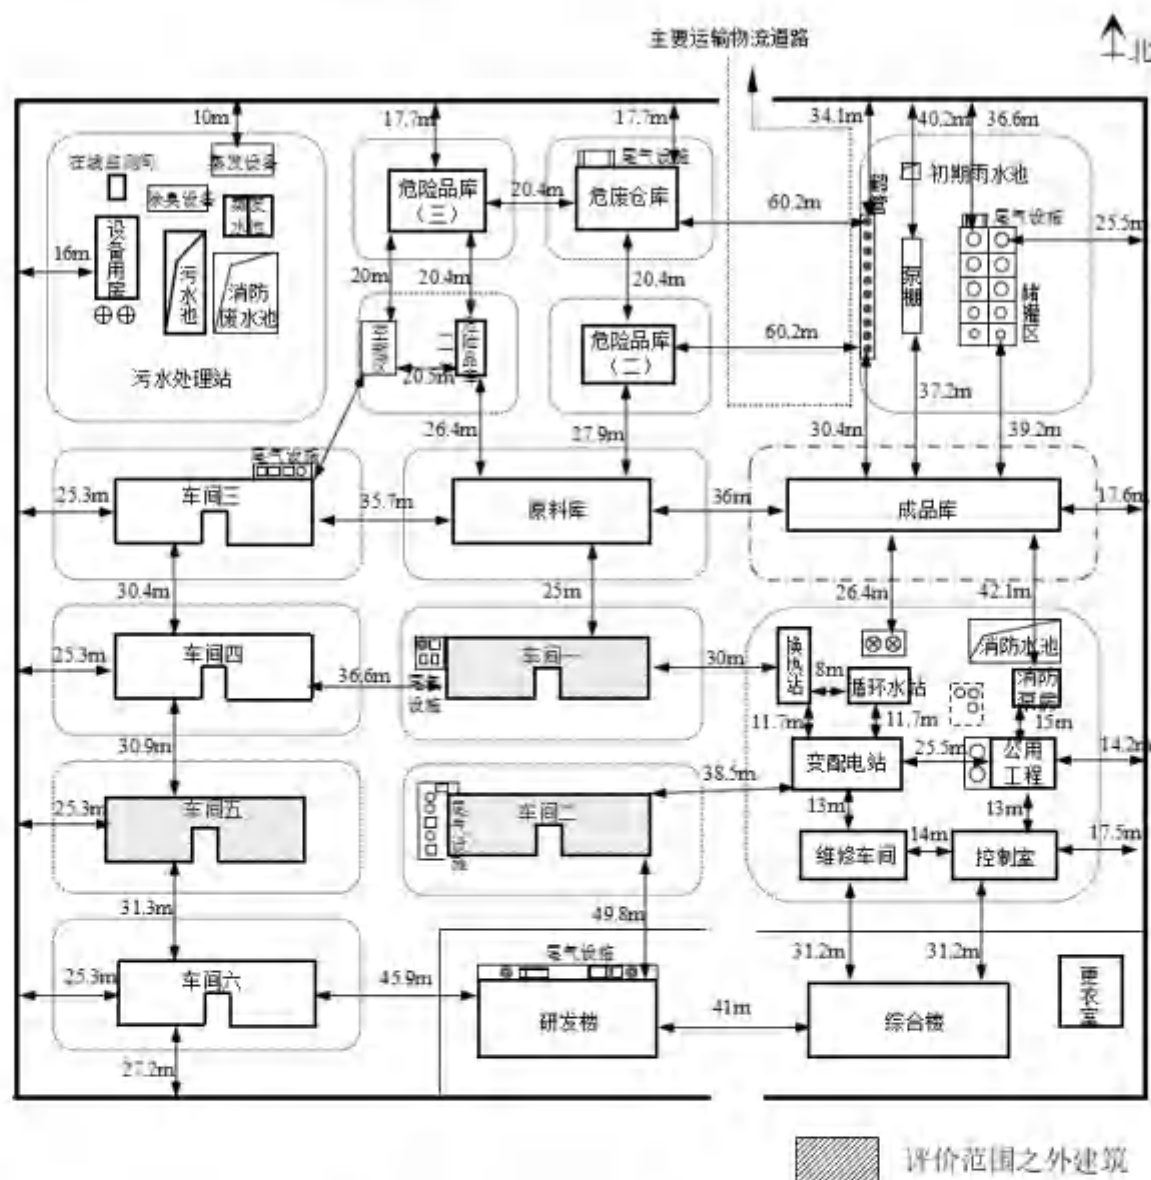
盘锦格林凯默科技有限公司厂区平面布置示意图
